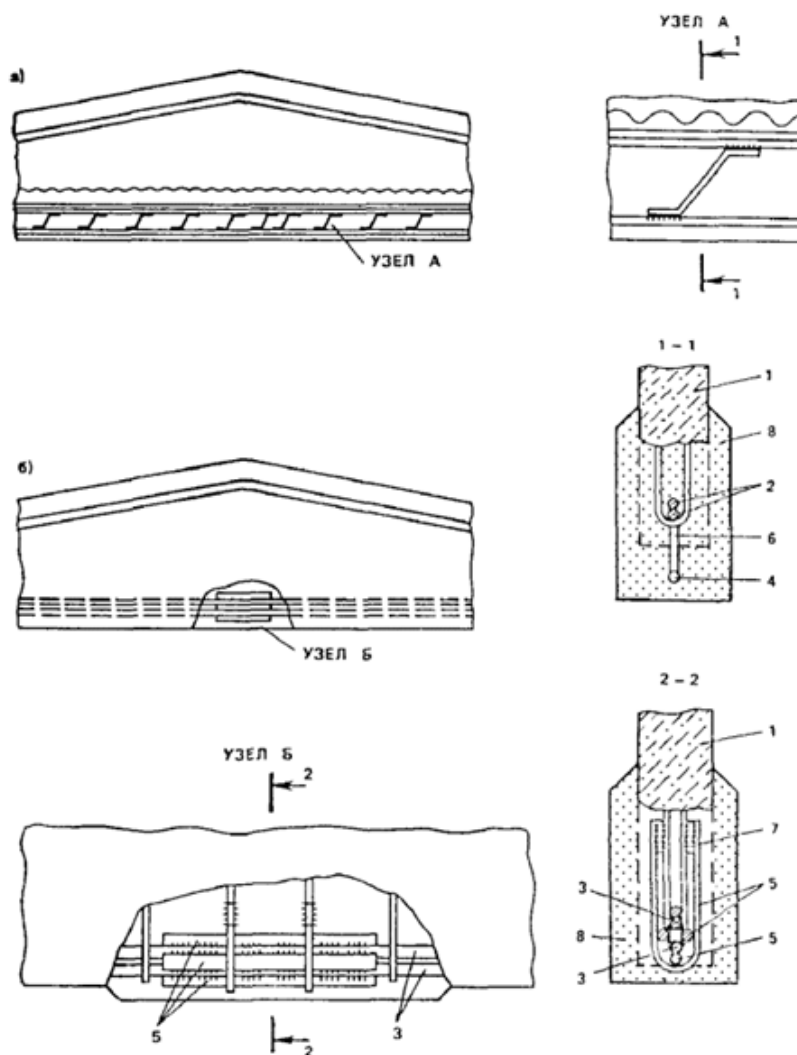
Підсилення збірних балок покриття: а - односторонні нарощуванням; б - накладками на зварці при розриві арматури; 1 – підсилювана балка; 2, 3 - арматура балки; 4 - додаткова арматура; 5 -
